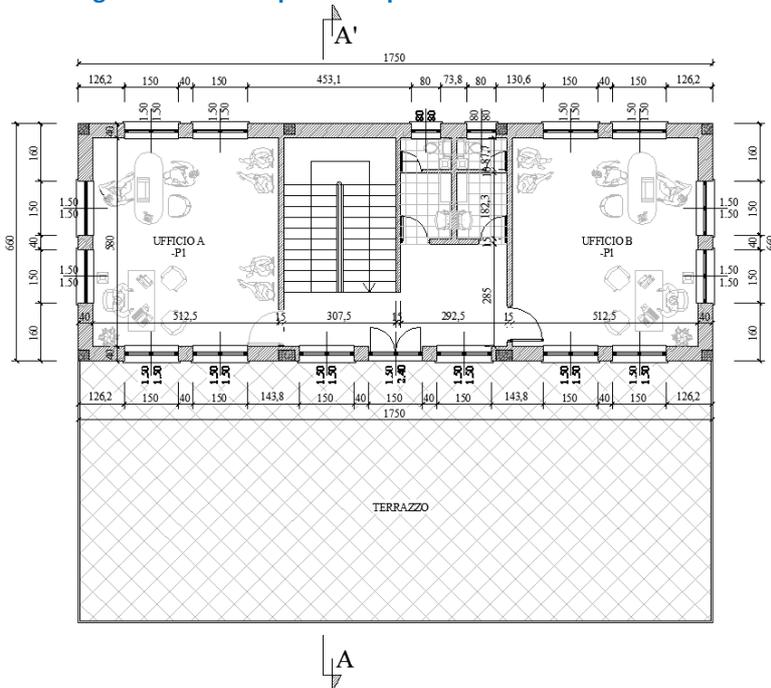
“Piccola palazzina per uffici. Pianta Piano primo”
